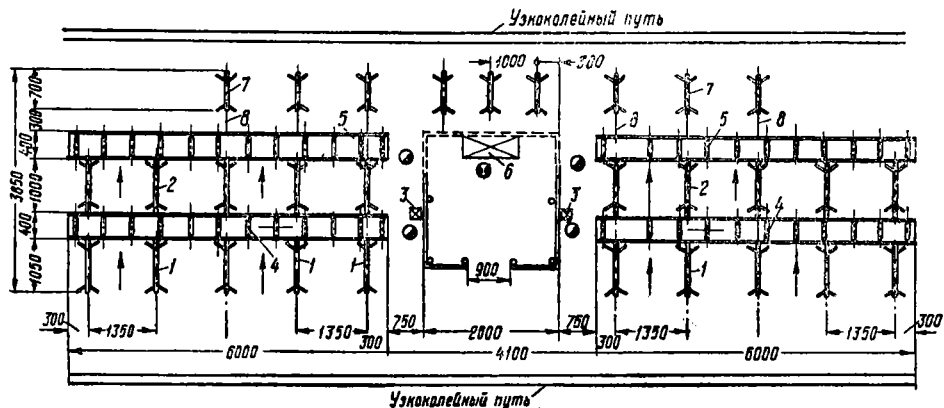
Организация рабочего места по заготовке арматуры: 1 — станок для резки; 2 — станок для выпрямления; 3 — стол для складывания нарезанной арматуры; 4 — мерная рейка и узкий роликовый стол; 5 — роликовые столы; 6 — станок для гнутья; 7 — узкоколейный путь
